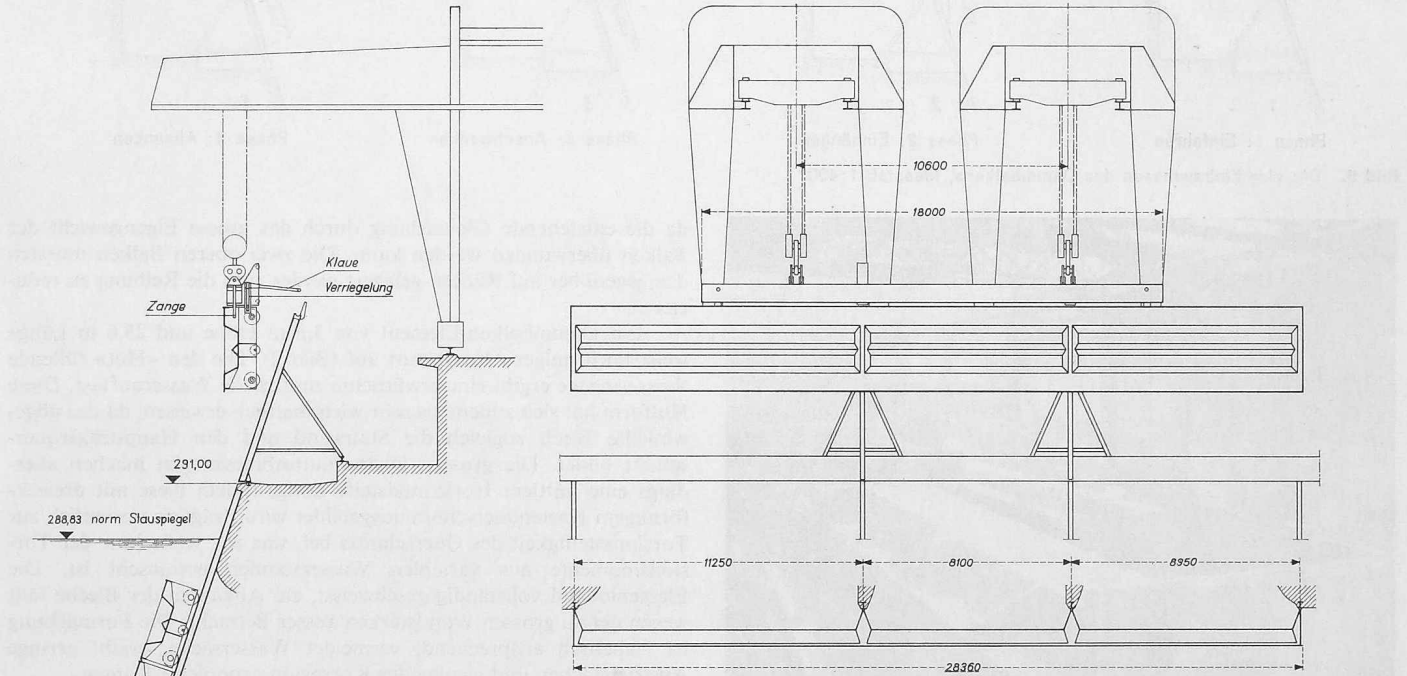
Uebersicht des Notverschlusses. Ansicht, Grundriss und Querschnitt 1:300
